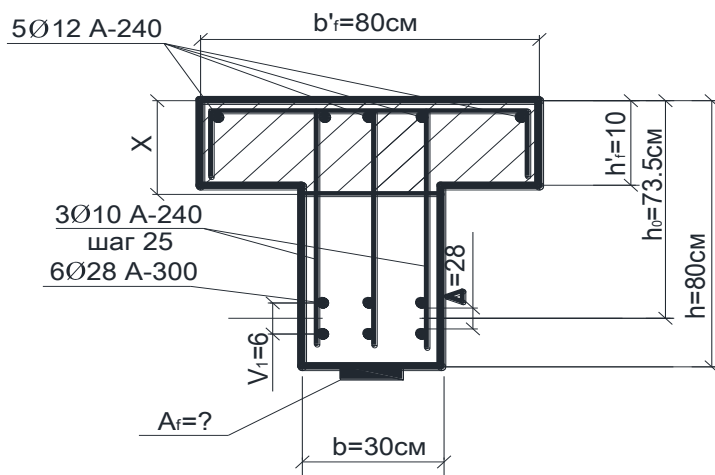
а. Расчетная схема усиления элемента таврового профиля
